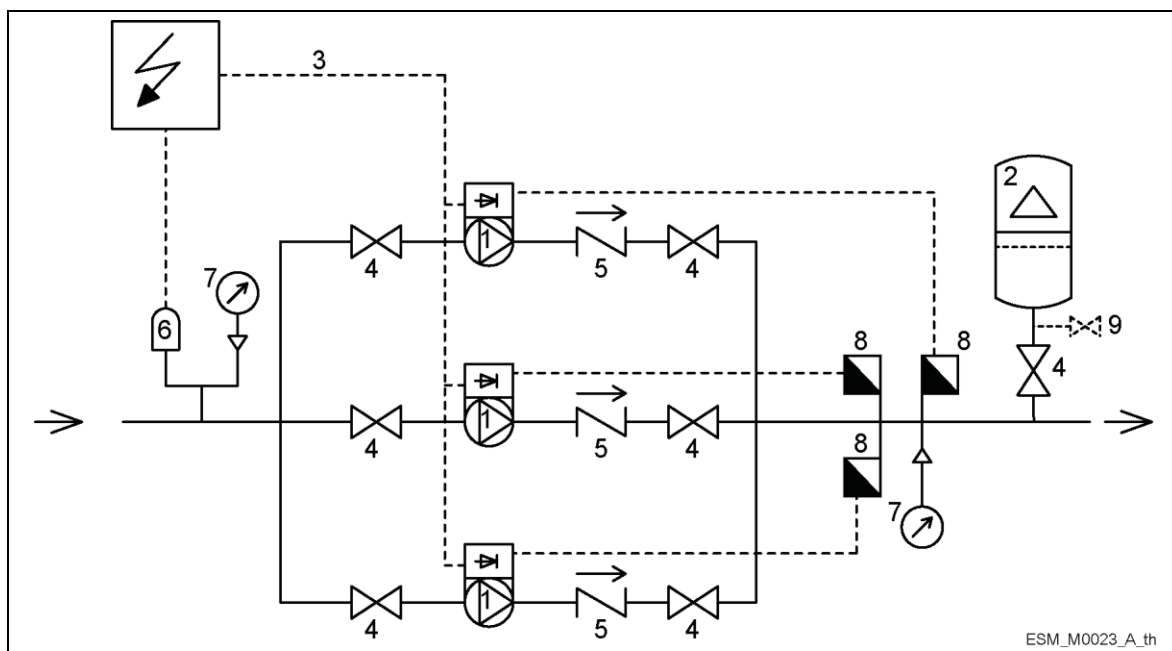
Montaż mechaniczny zestawu urządzeń wspomagających
